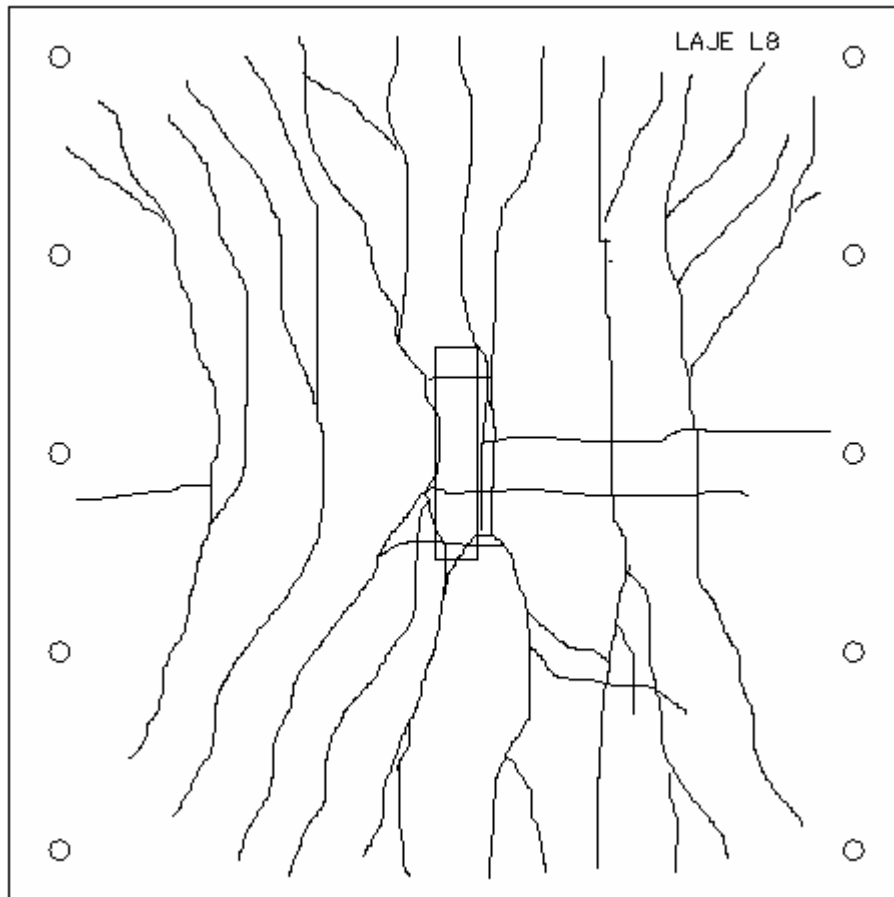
Mapa de fissuração da laje L8
